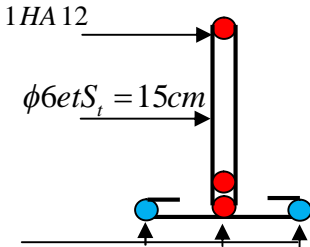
3. Schéma de ferrailage de la dalle de compression
